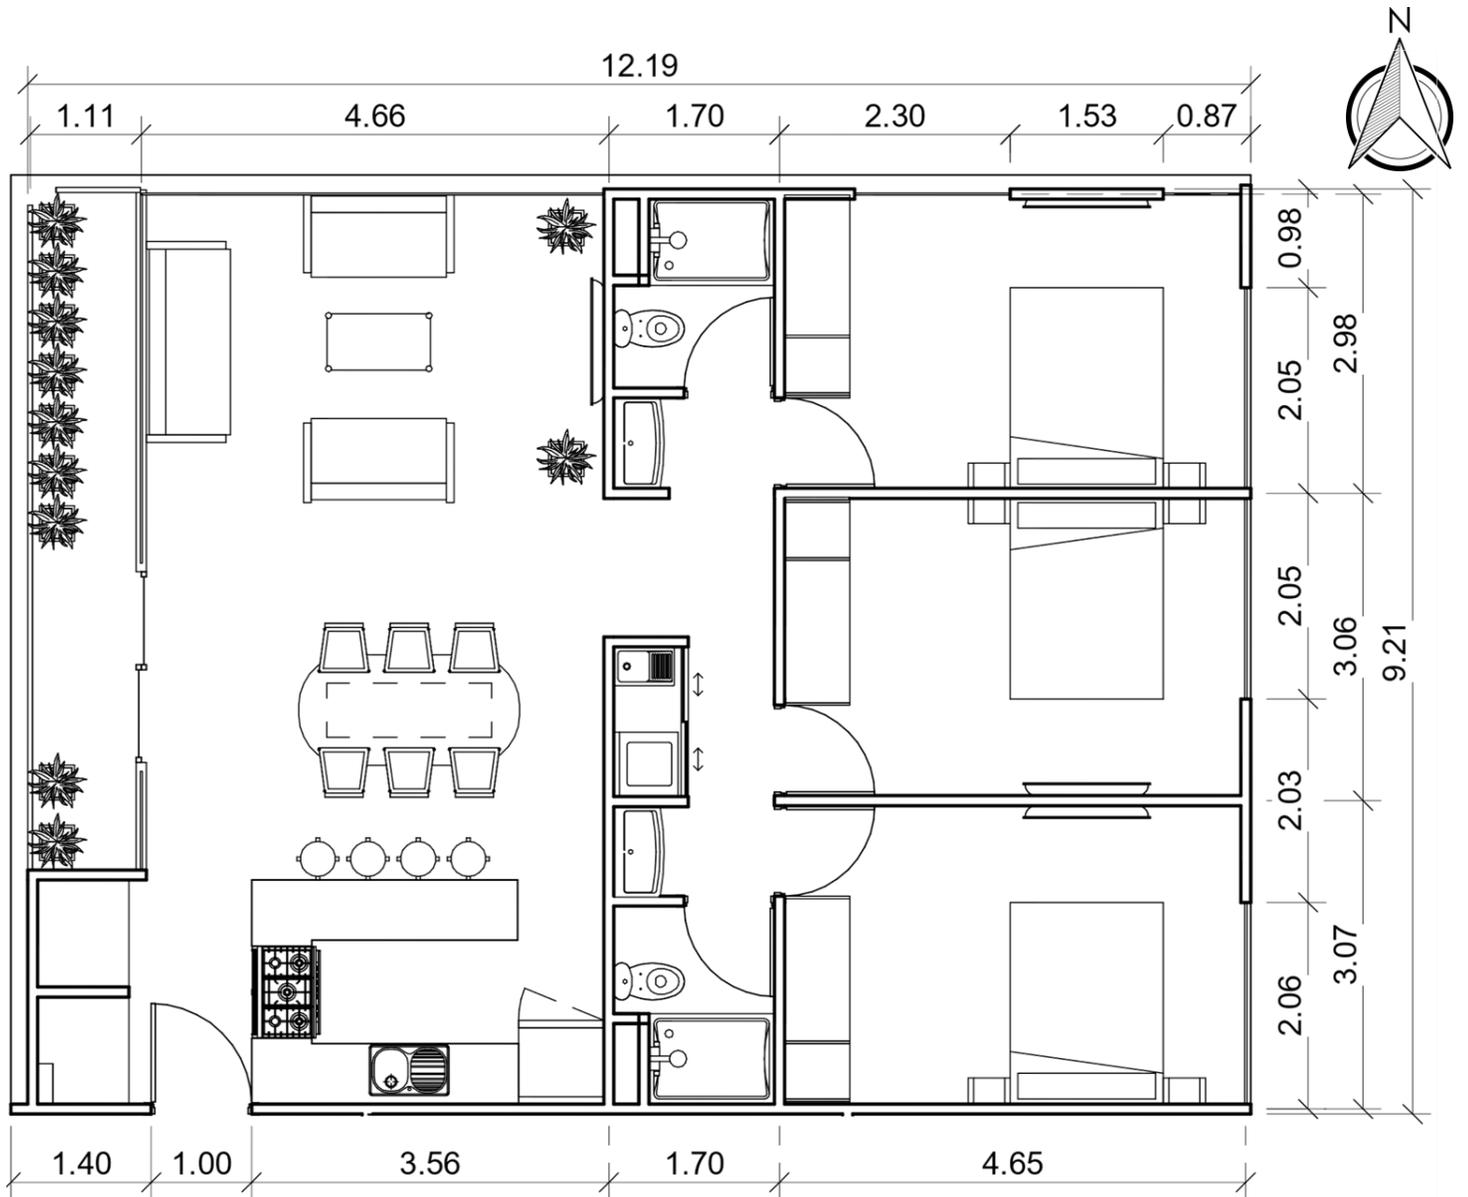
Propuesta final. Planta vivienda Norte. Elaboración propia. 2022
